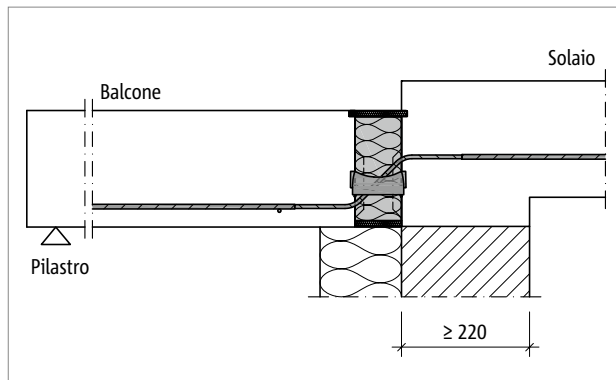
Schöck Isokorb® T tipo QL: situazione di posa con lieve salto di quota
